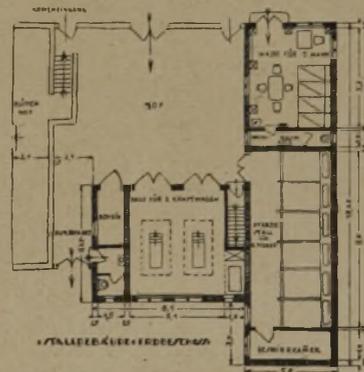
und 27. Grundrisse der Stallgebäude.
